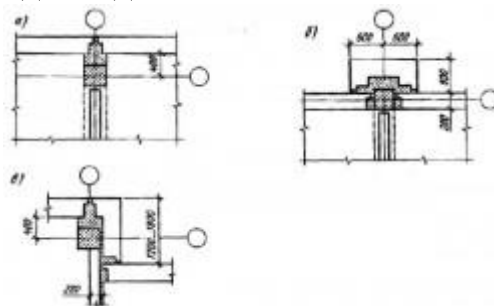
Привязка наружных стен каркасных зданий к координационным осям: а — рядовых стен, б — стен с пилястрой, в — стен с уступом 1200... 1800 мм
